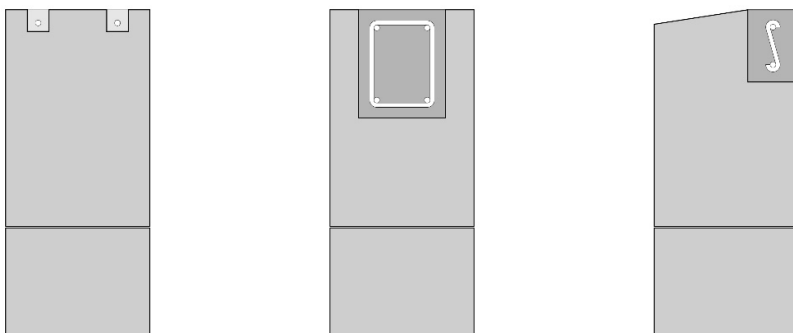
, esquemas de antepechos, refuerzo con 2 varillas en canaleta, carrera de 12x15 en bloque U, macizo bajo abertura
